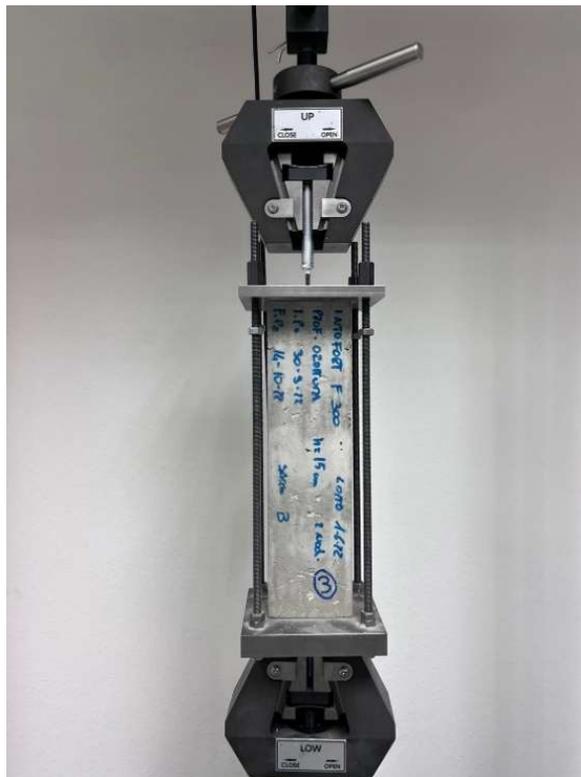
Macchina di prova, Matest Unitronic 200 kN
